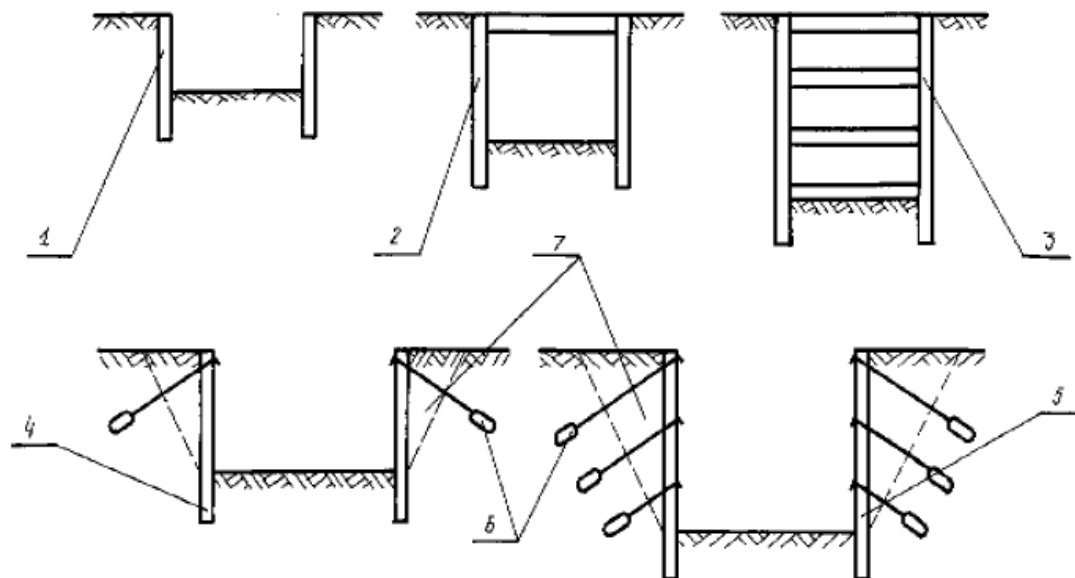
Конструктивные схемы подземных сооружений: 1 – консольная стена; 2-3 – стены с одно- и многоярусным креплением распорками; 4-5 – стены с одно- и многоярусным креплением анкерами; 6 – грунтовые анкеры; 7 – призма обрушения.
